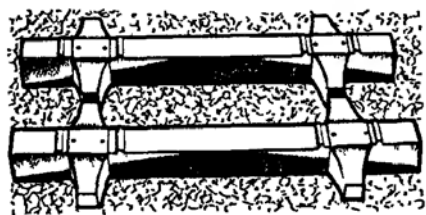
Железобетонные шпалы гига Вр. 14d для крутых кривых (Австрия)
